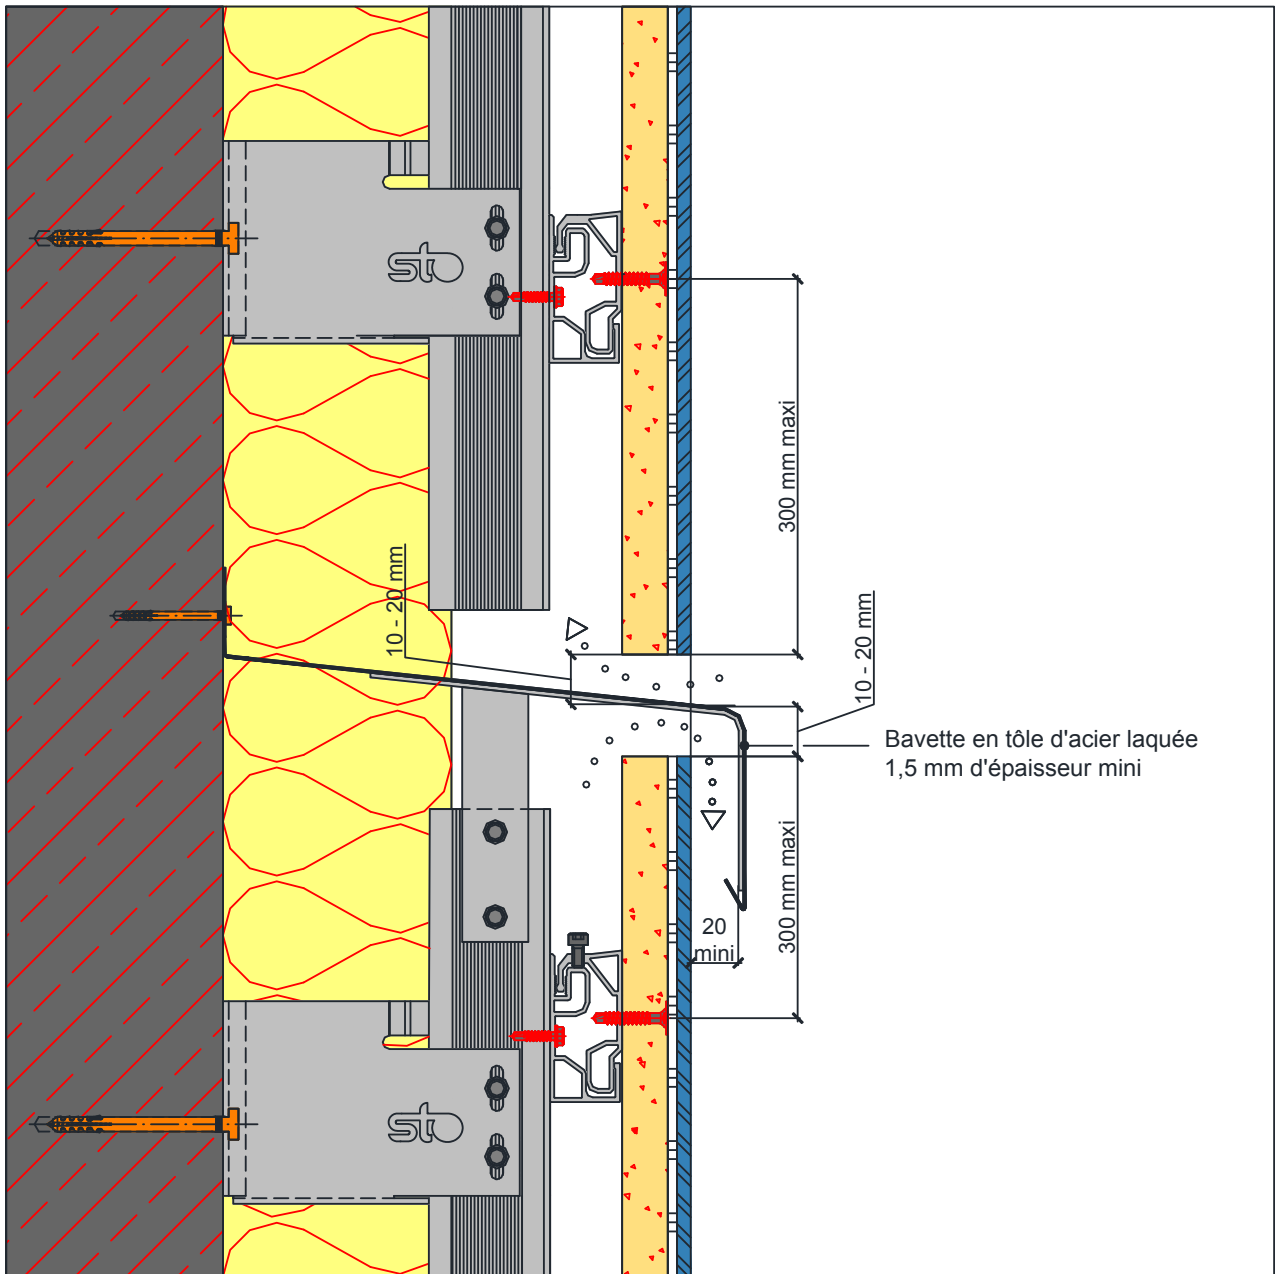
Aboutage rails horizontaux sur ossature primaire métallique
